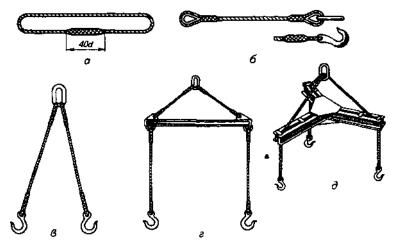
Приспособления для строповых устройств и монтажных блоков: а — универсальное; δ — облегченное; δ — многоветвевое; ε — захват; δ — траверса
